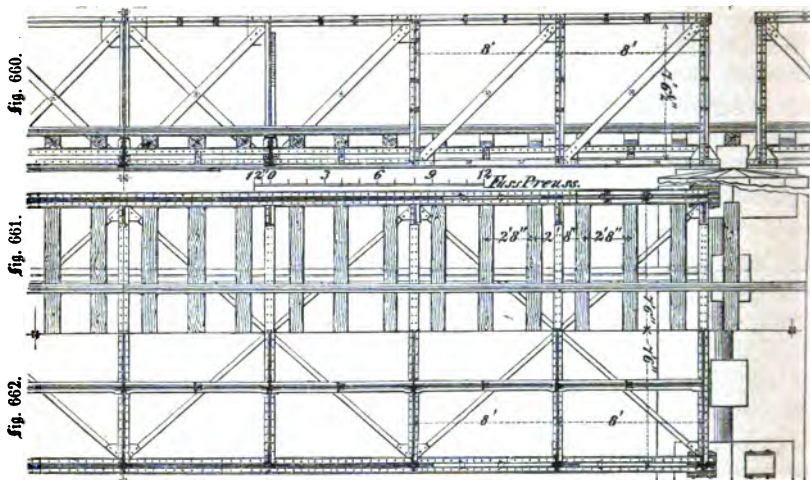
bis 662. Ansicht und Grundriß der kleinen Oeffnung der Brücke über den Alten Rhein bei Griethausen.
